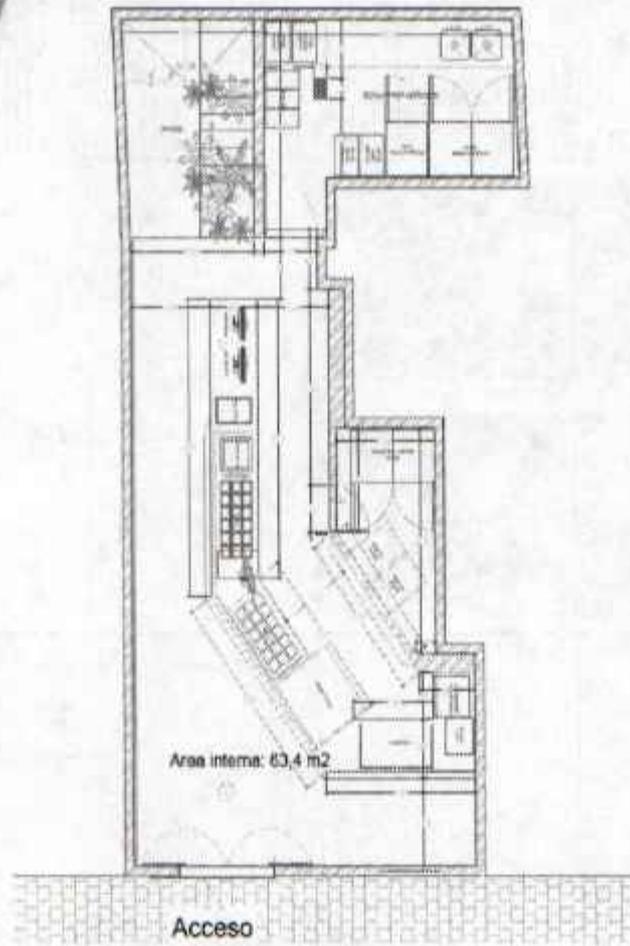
Plano PÉRCIMON CARTAGENA – Área privada
